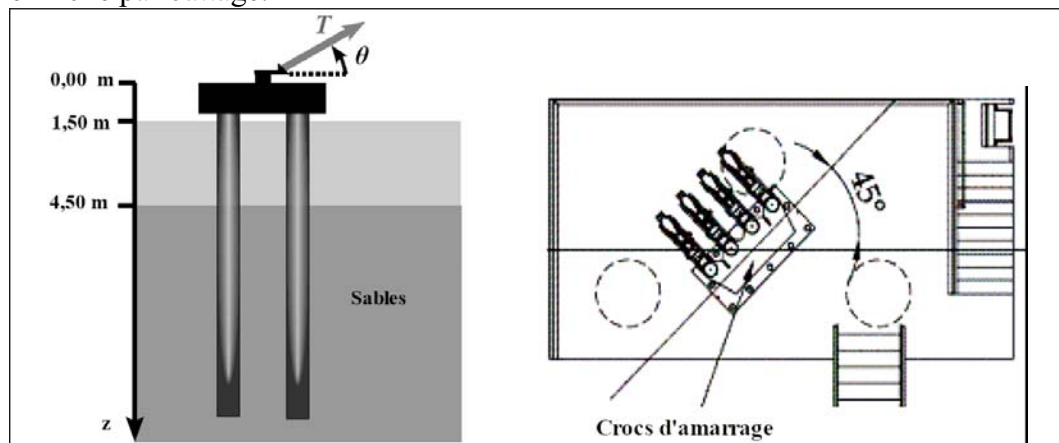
Coupe longitudinale et vue en plan du duc d'Albe d'amarrage
